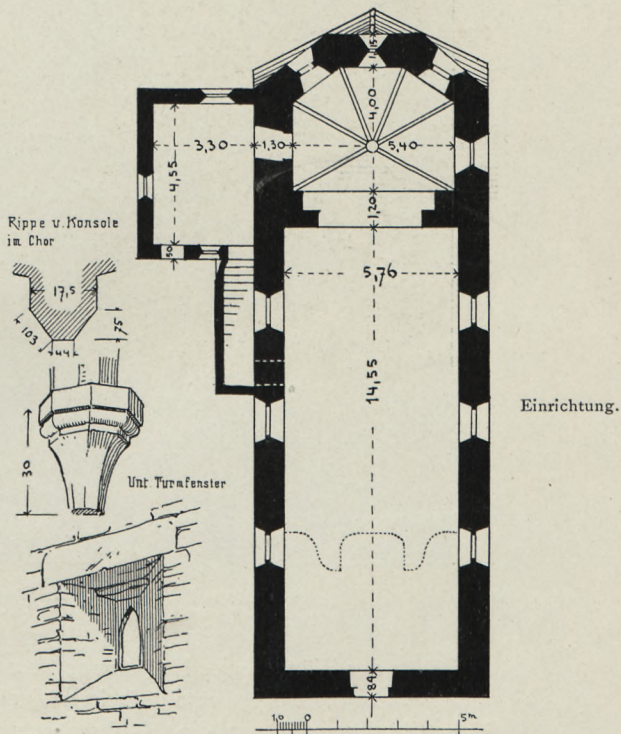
Schmidgaden. Pfarrkirche. Grundriß und Details.
